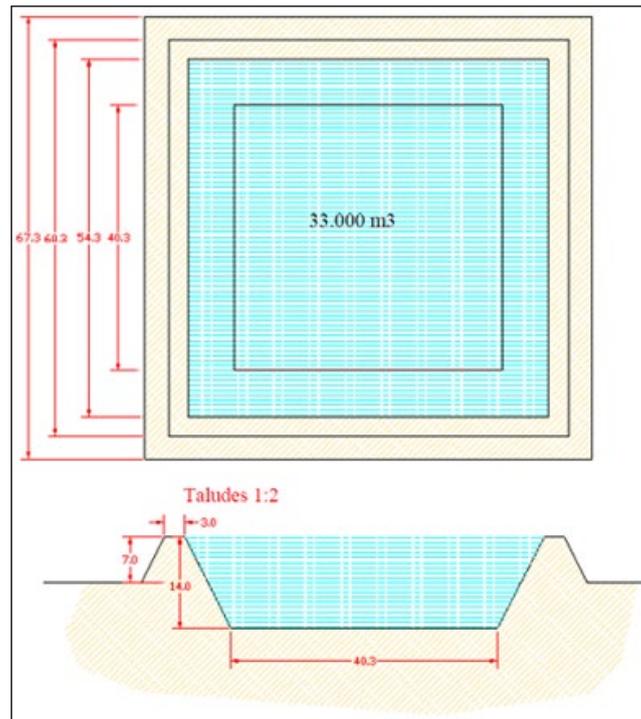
Vista en planta y sección de la balsa reguladora de las aguas regeneradas de la EDAR de Barranco Seco en El Fondillo. Fuente: elaboración propia
